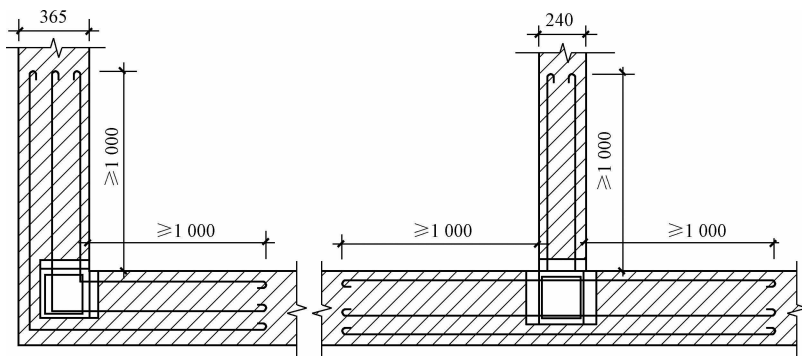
一砖半墙转角处及交接处构造柱水平拉结钢筋布置
